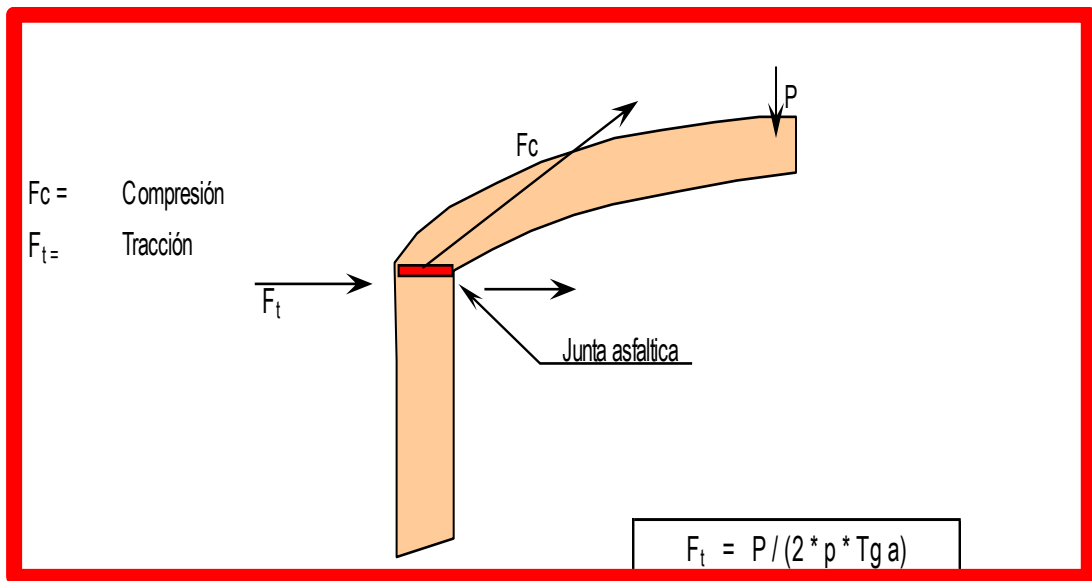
Detalle de cargas actuantes hacia la losa del techo
